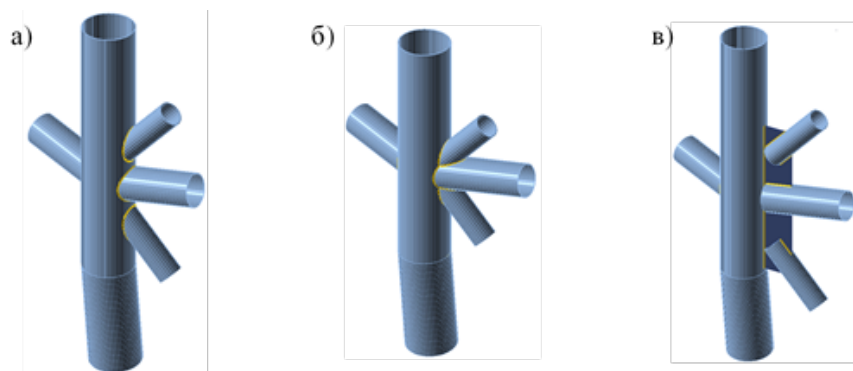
Варианты конструкций монтажного узла: а) первый вариант – исходный; б) второй вариант – трубы сдвинуты; в) третий вариант – трубы приварены через фасонку.
